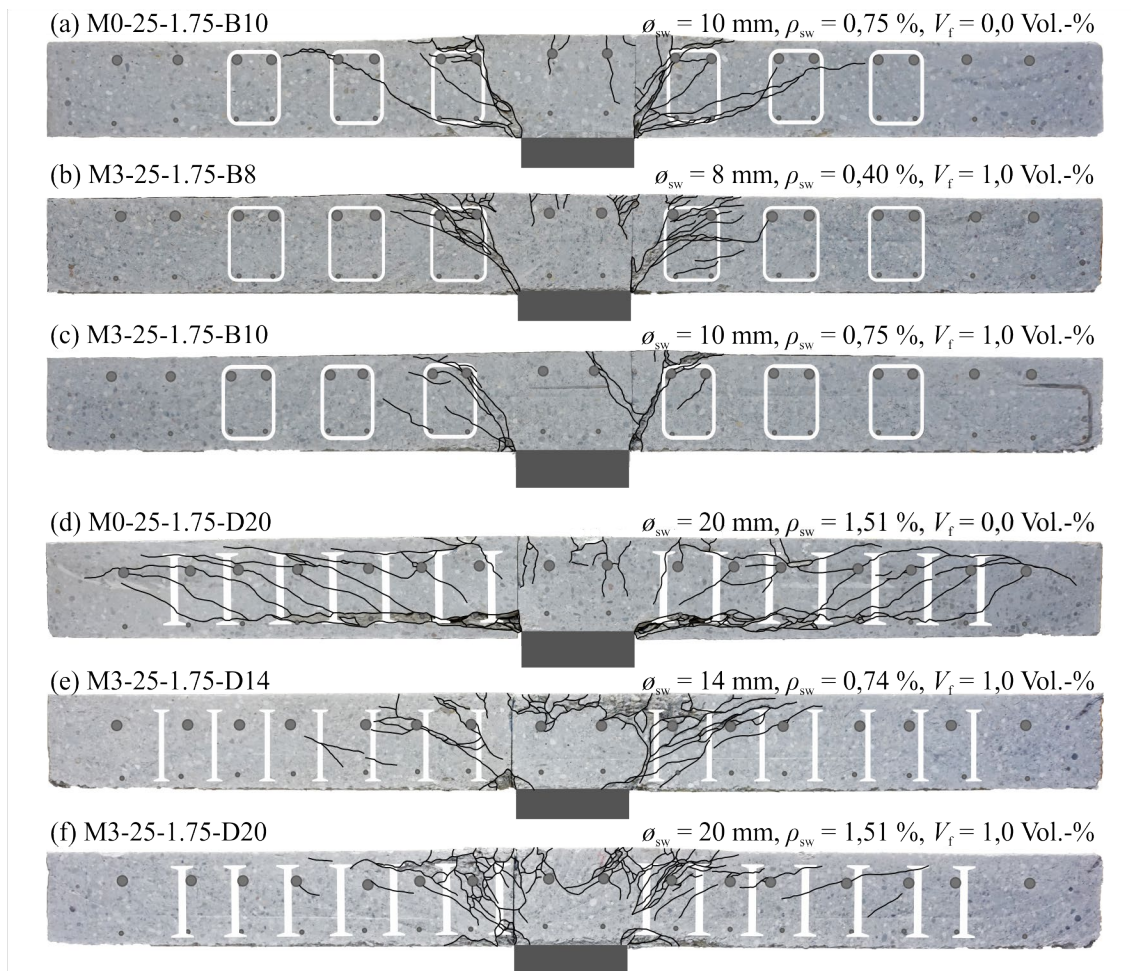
Tremschnitte der geprüften Flachdeckenausschnitte mit geschlossenen Bügeln ((a) bis (c)) bzw. Doppelkopfbolzen ((d) bis (f)) als Durchstanzbewehrung
